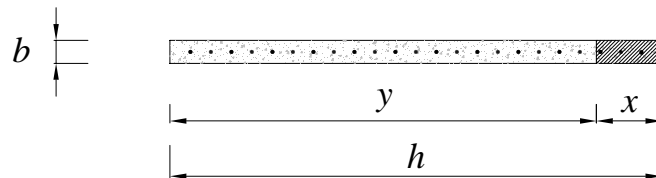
Sezione rettangolare in c.c.a. con armatura diffusa in condizioni fessurate.
